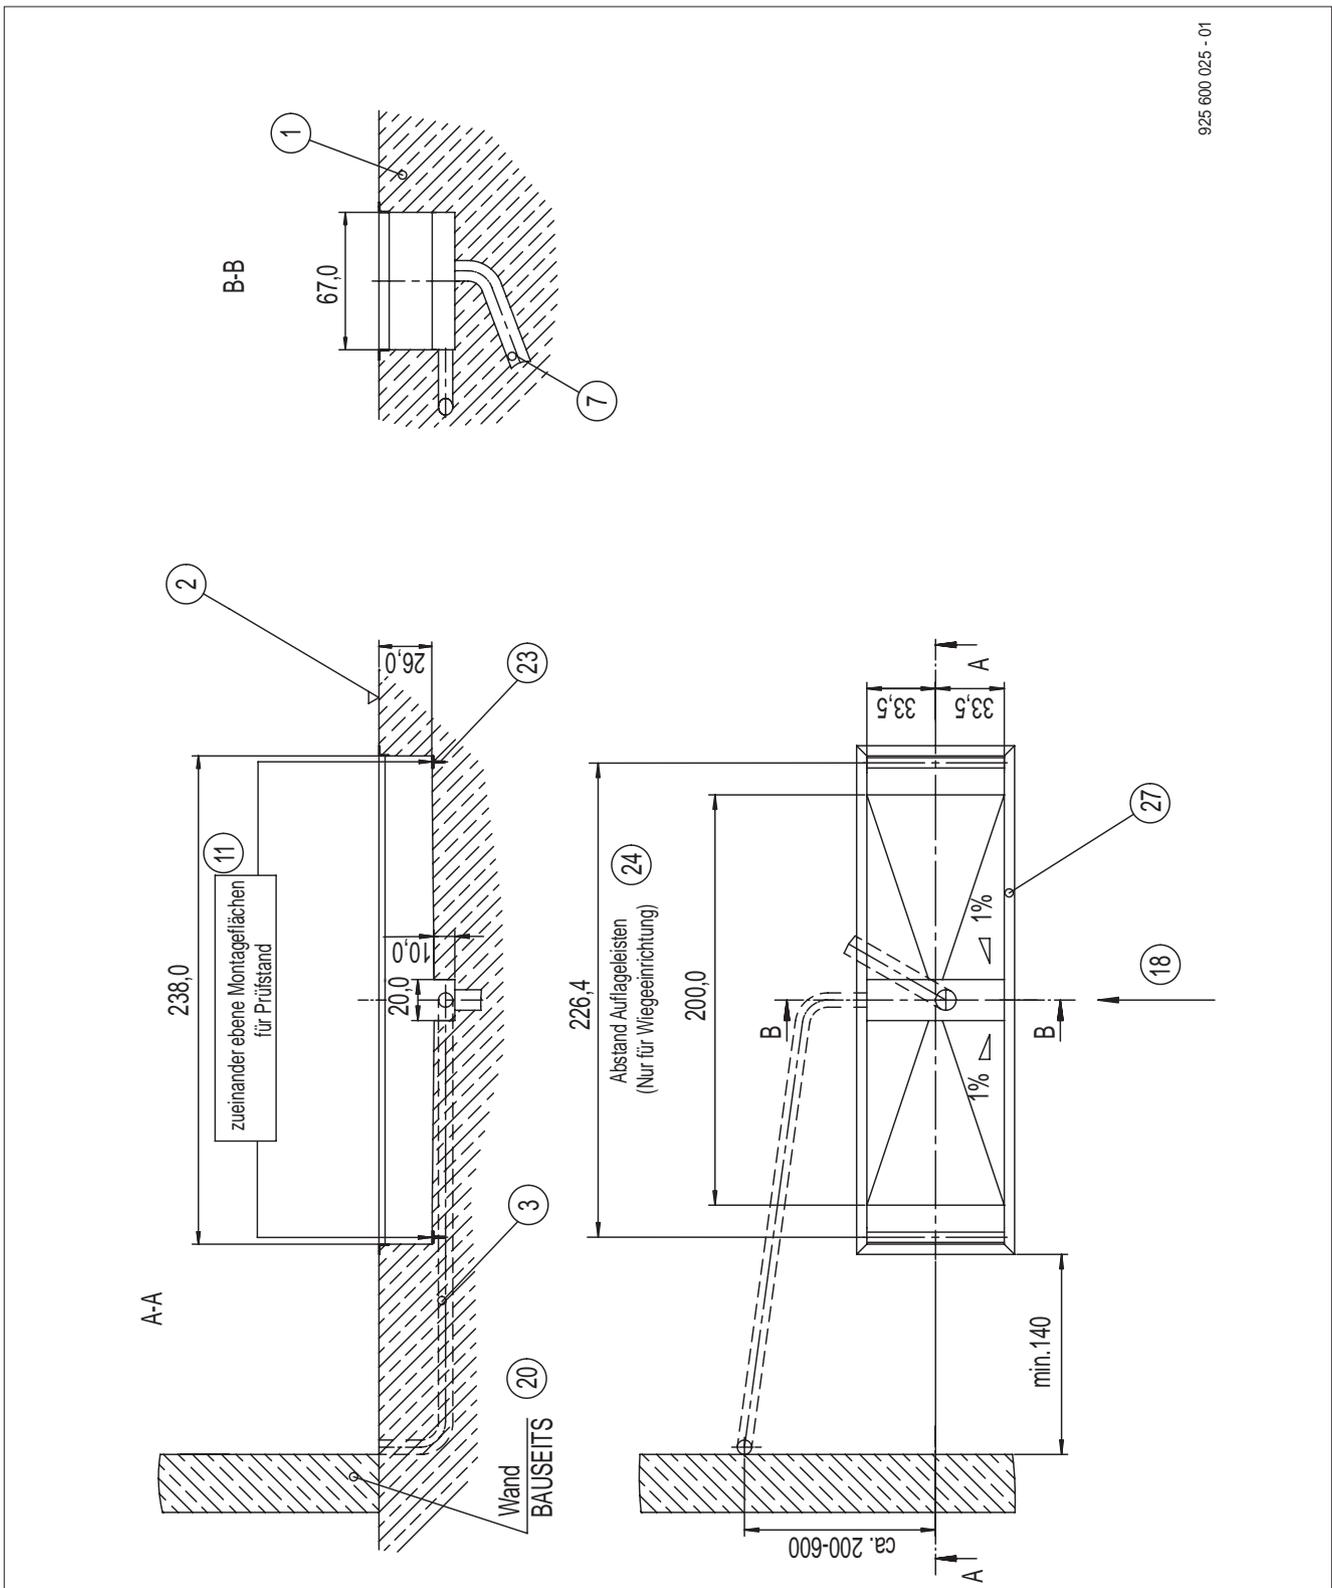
Grubenplan BD 6xx mit Wandhalterung - Übersicht
